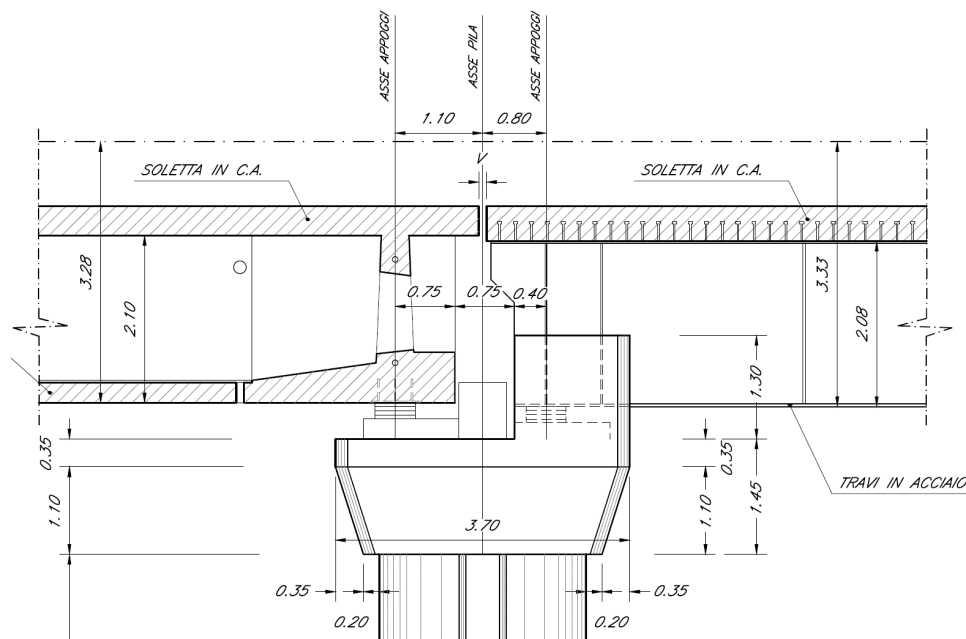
Pila, prospetto longitudinale – Impalcato CAP e impalcato a struttura mista [m]
